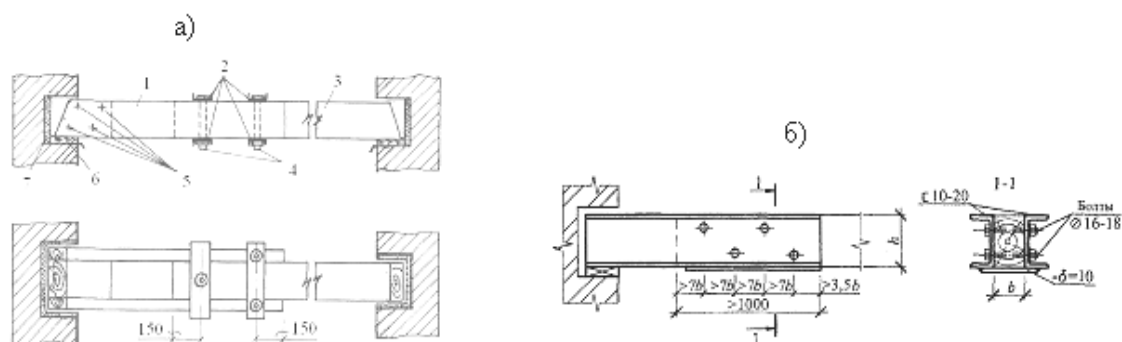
Усиление деревянных балок деревянными (а) и металлическими (б) накладками: 1- накладка; 2- поперечины из швеллера; 3- усиливаемая балка; 4- болты; 5- гвозди; б- антисептированная подкладка; 7- теплоизоляционный слой
